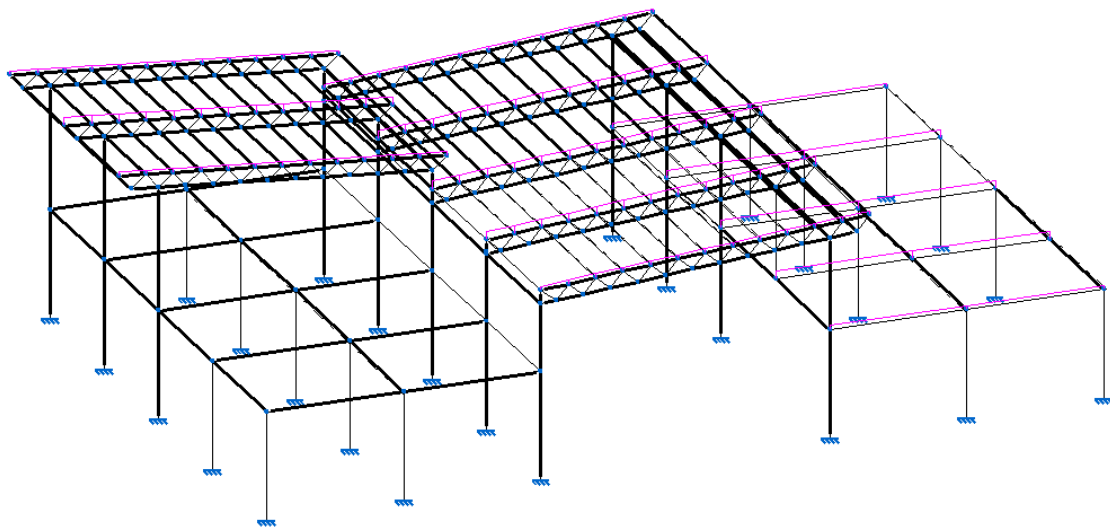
Sobrecargas en estructura metálica. Fuente: Elaboración propia
